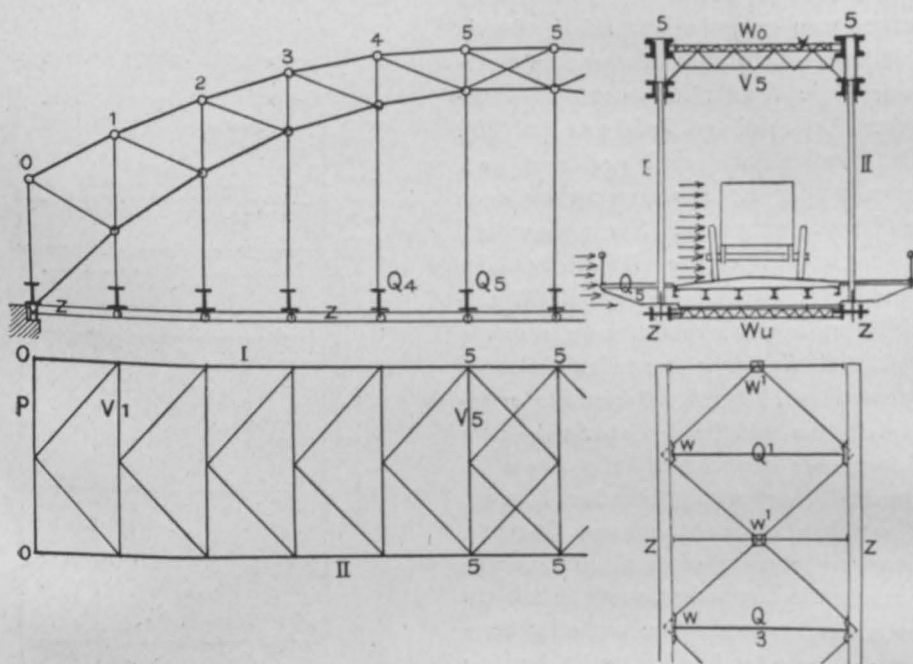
Ansicht, Querschnitt und Grundrisse der Querverbände einer Bogenbrücke mit Zugband.
